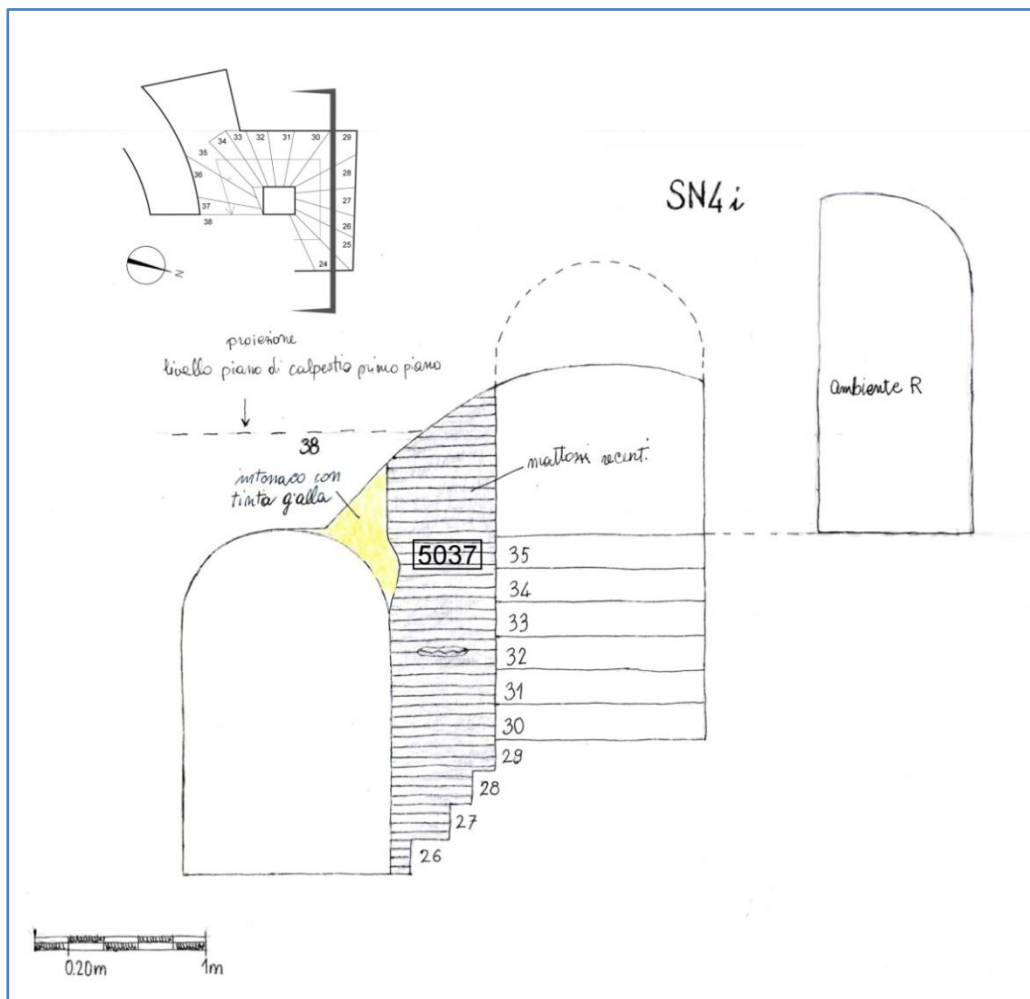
Prospetto SN4i. Disegno D'Ippolito.
